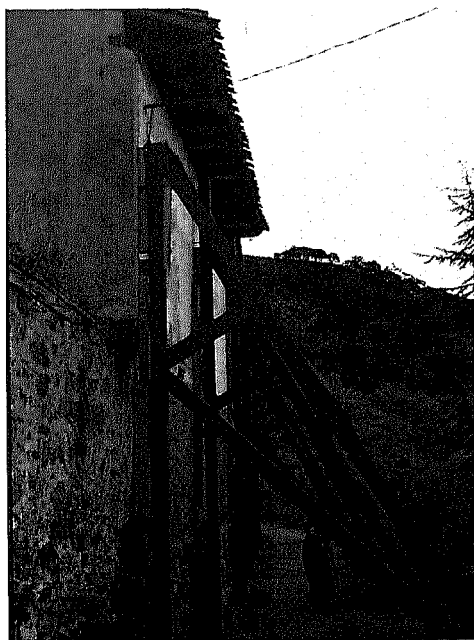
Apeos metálicos que protegen el muro sur del edificio y que están conectados con los apeos interiores del atrio.
